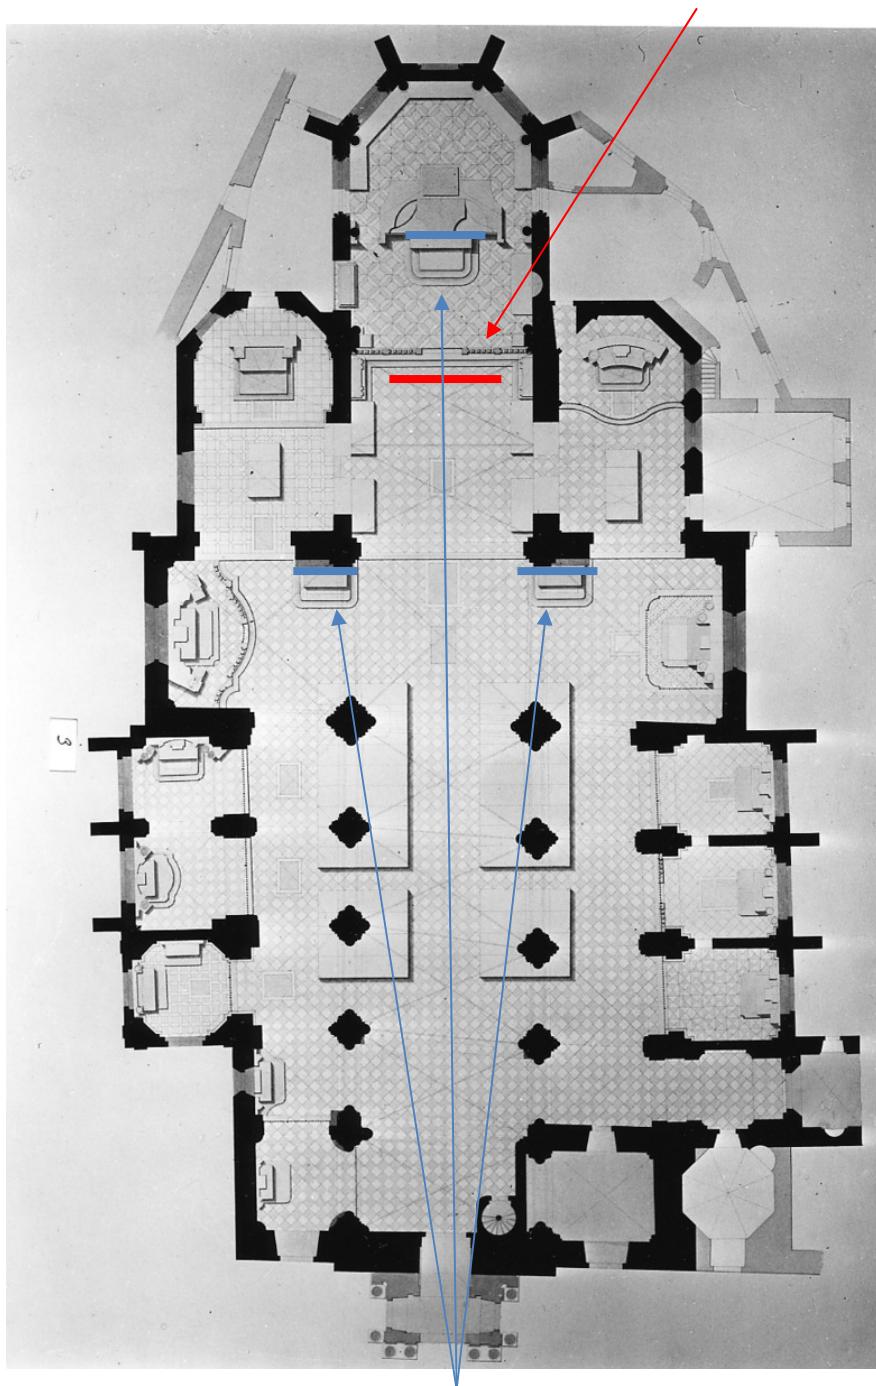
Wien, St. Michael, Fastentuch, 2004, mit Grundriss
